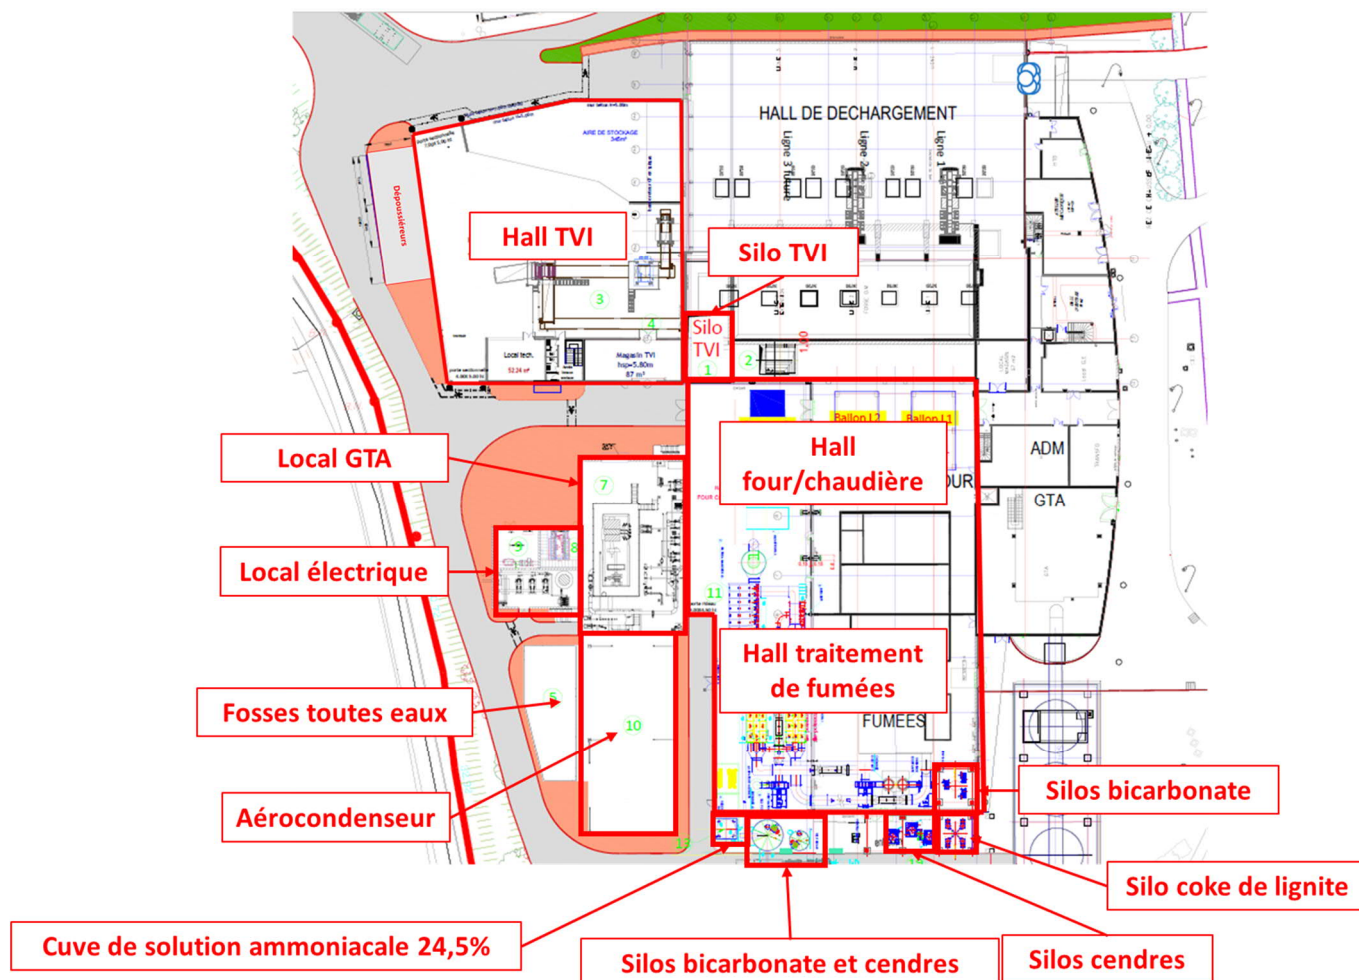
Localisation des nouvelles installations et installations connexes sur le site (dans le CVE)
